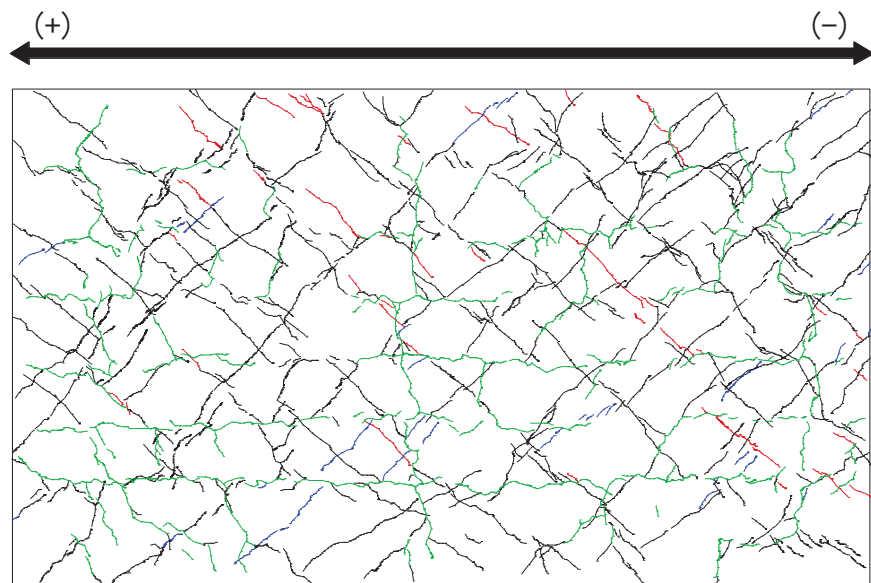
(10) 乾燥試験体 [2] 1/333rad. におけるひび割れ図
